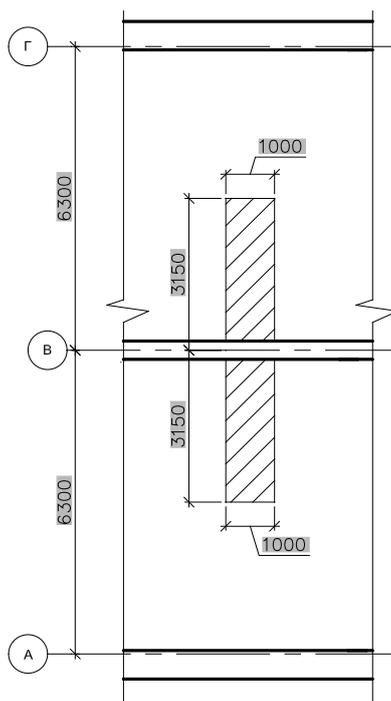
Грузовая площадь при расчёте фундамента внутренней стены
